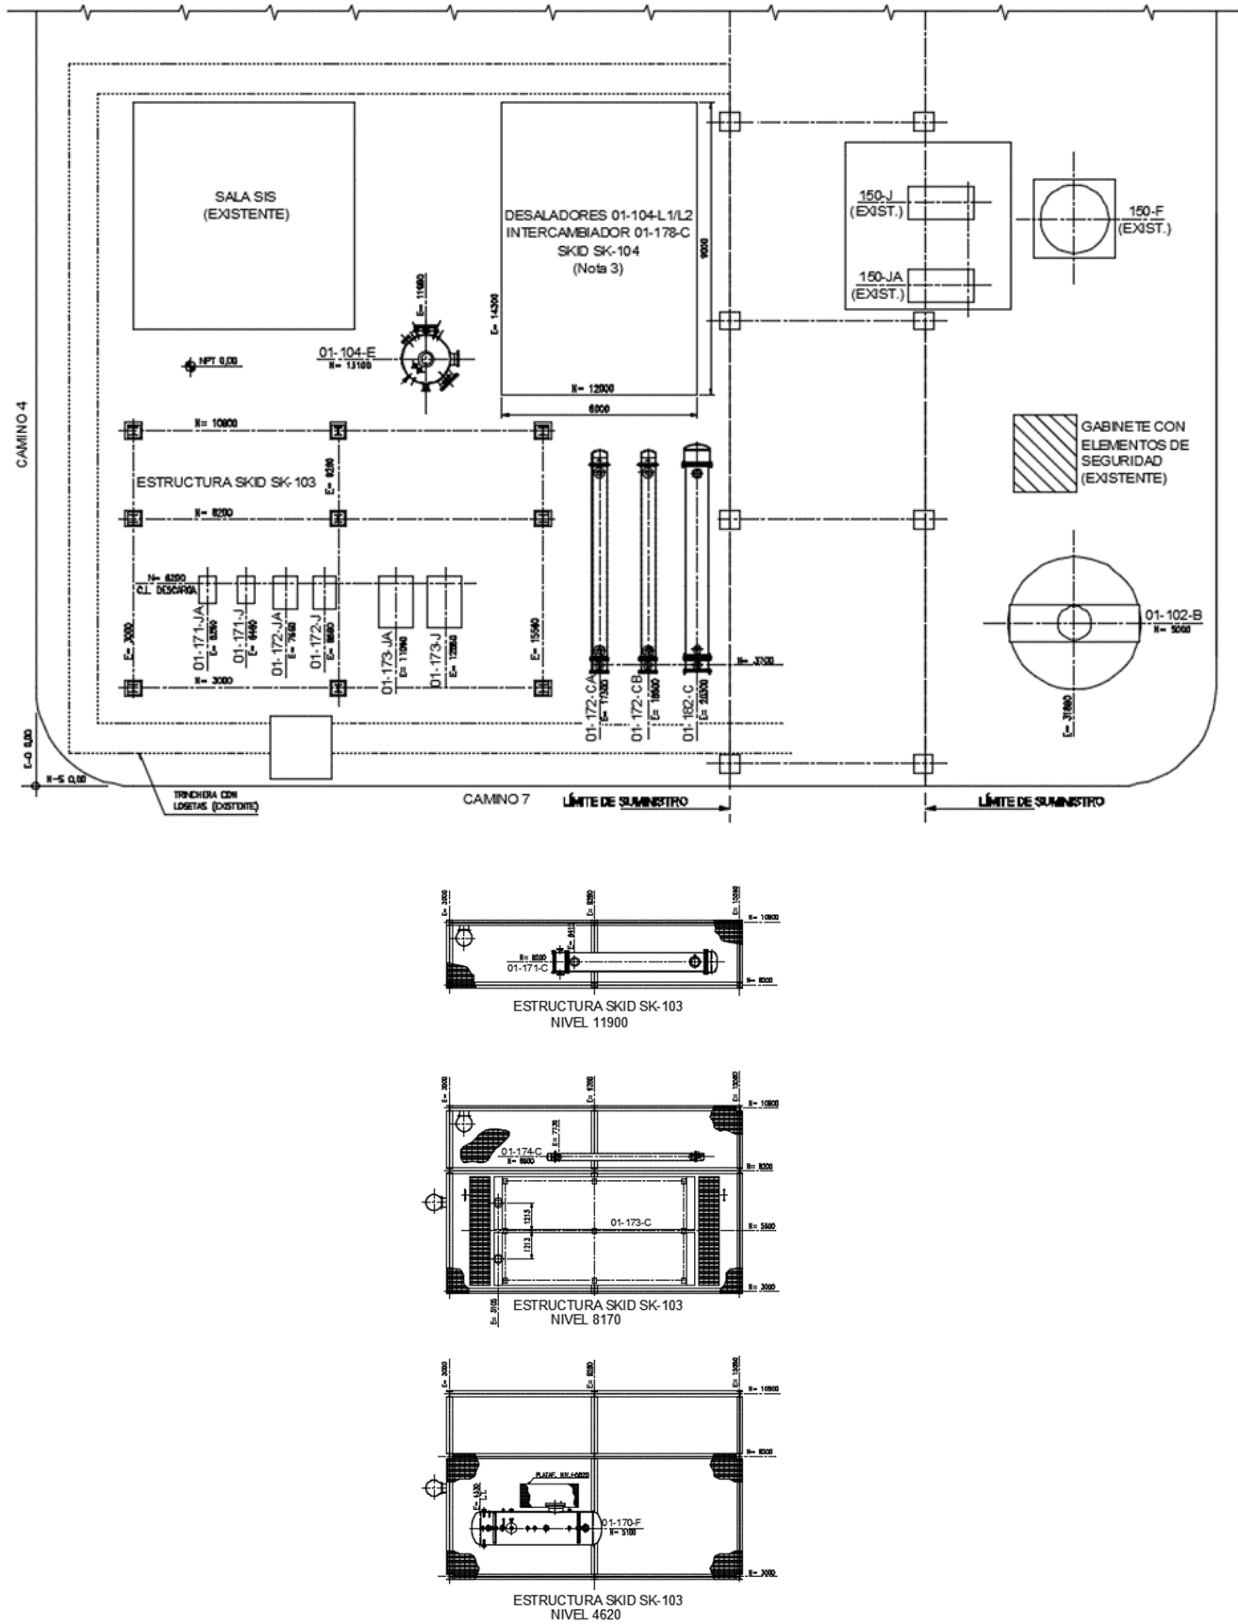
LayOut de implantación y elevaciones del modulo SK-103
